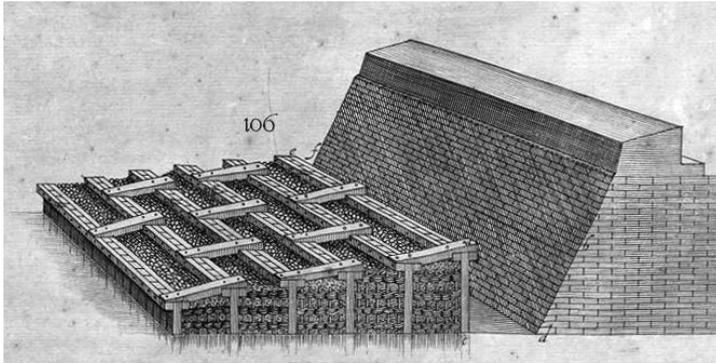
Plano de 1721 que muestra la sección de la muralla que se debía construir y la escollera sumergida
